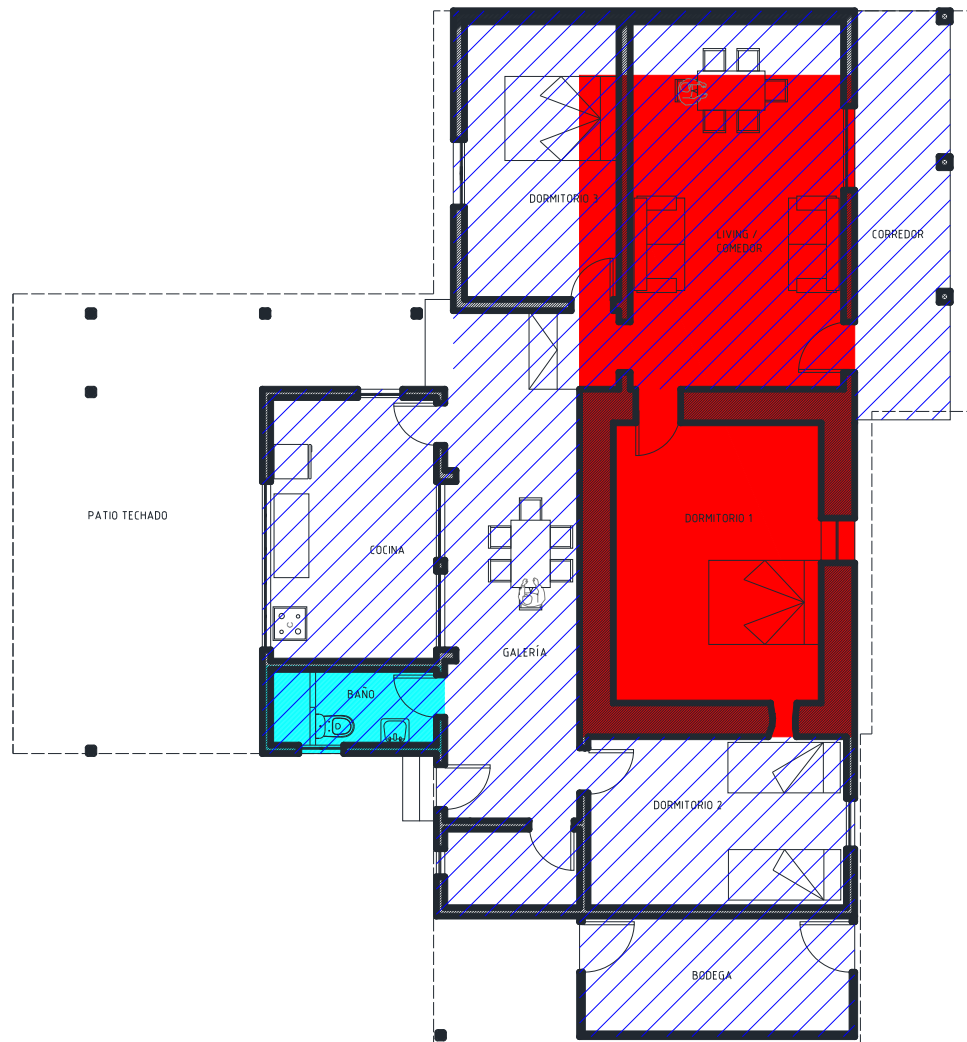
Planta de la casa de una de las entrevistadas (misma de la figura anterior), antes de su reconstrucción, mostrando con cian el recinto de baño, con rojo el espacio que habría usado el módulo original de adobe y con achurado azul las adiciones posteriores..
